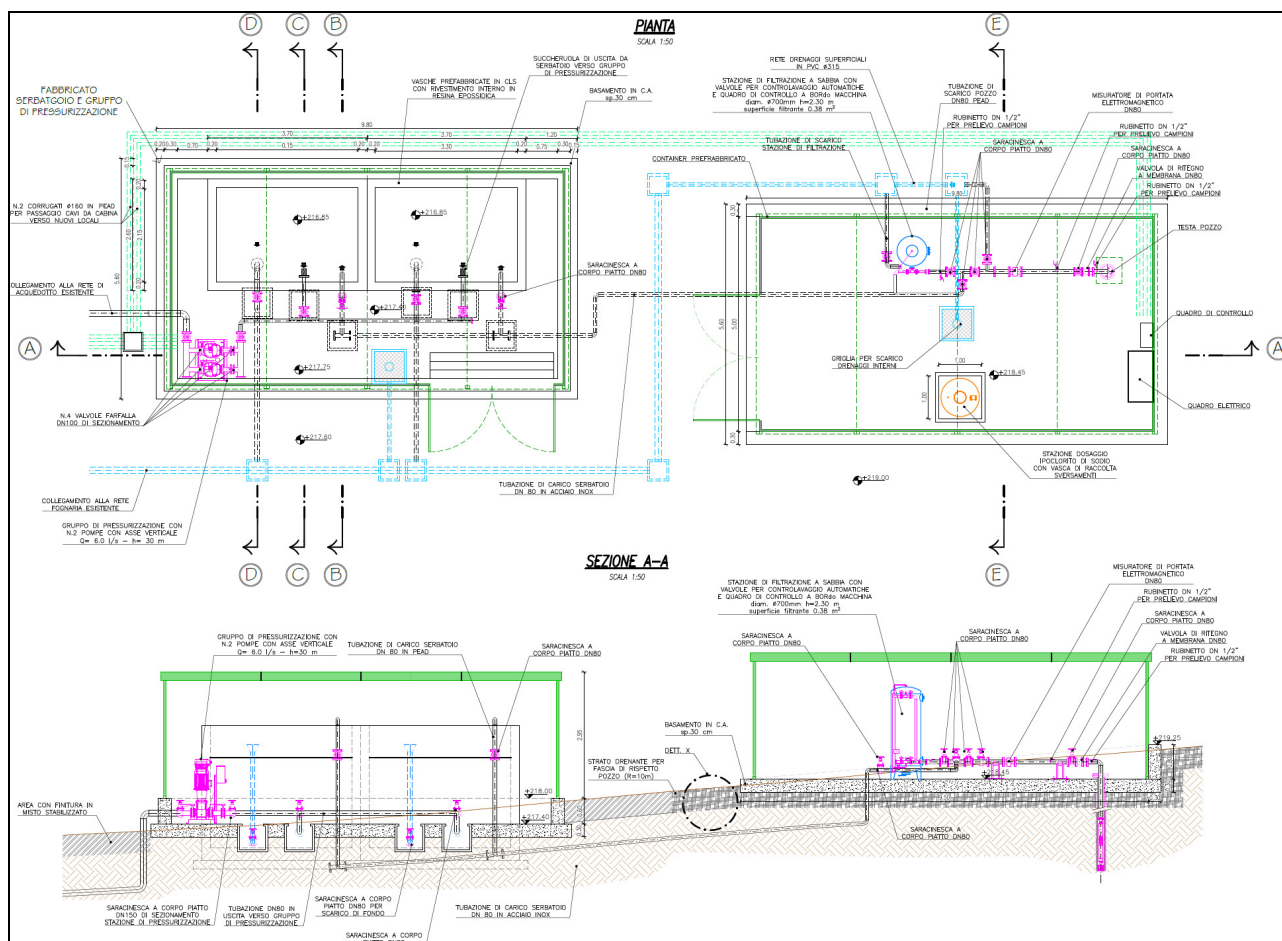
Planimetria e sezione dell'intervento in previsione
